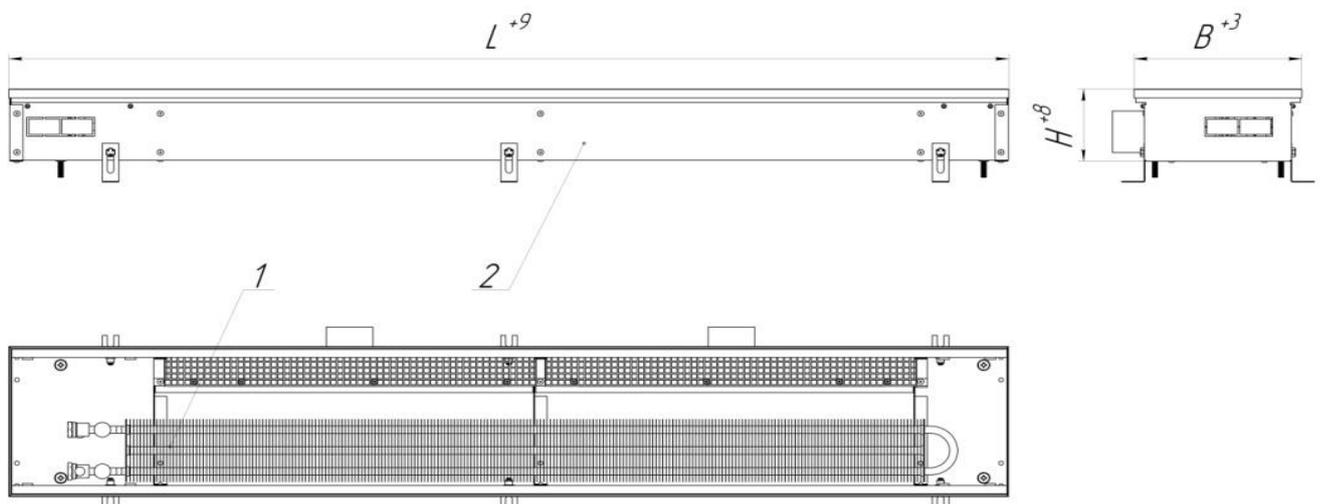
Общий вид конвектора Techno Air без решетки.
